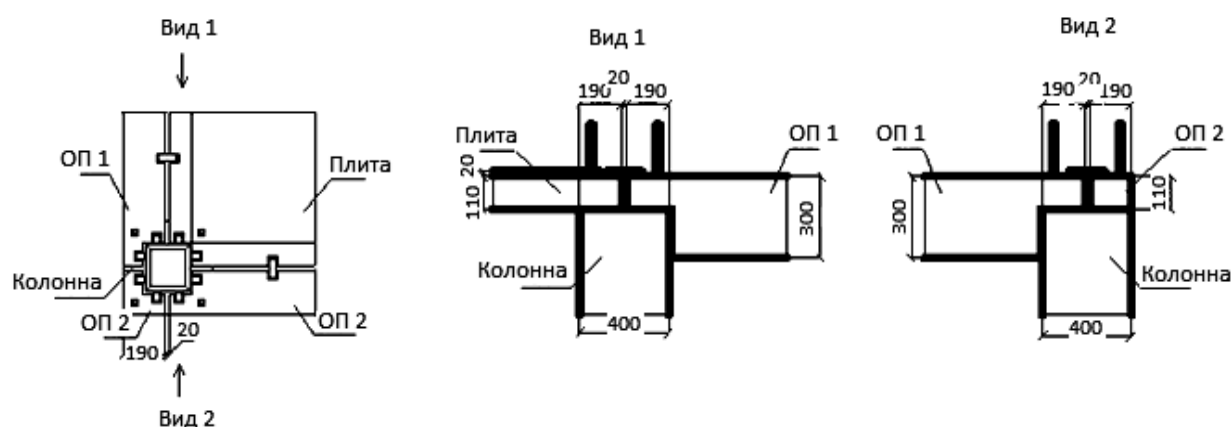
Узел сопряжения плит перекрытия с опорными вкладышами и колоннами
